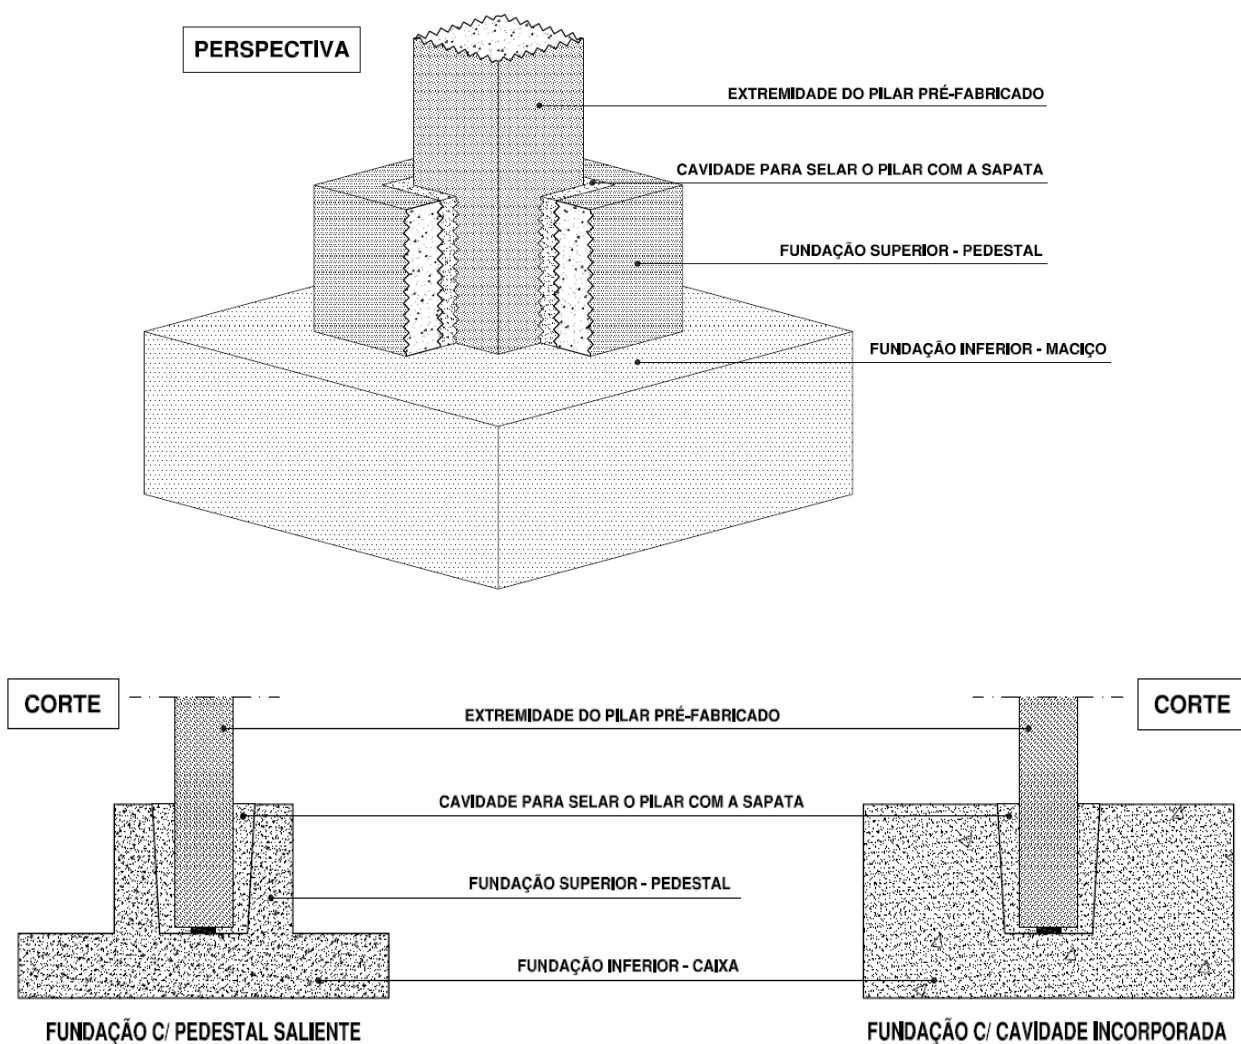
Ligação pilar-fundação com cavidade (adaptado de [1])
